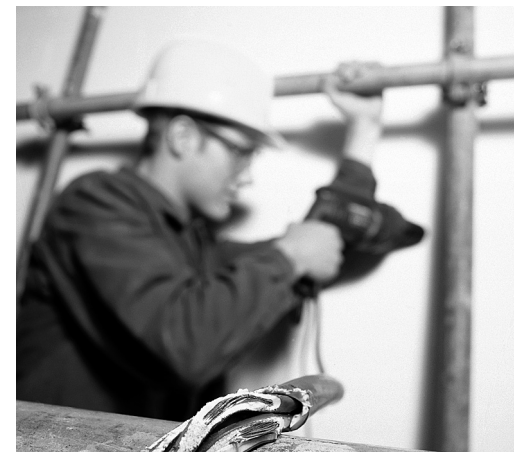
Stecker, Kabel und Elektrowerkzeuge vor Gebrauch auf Schäden kontrollieren.
